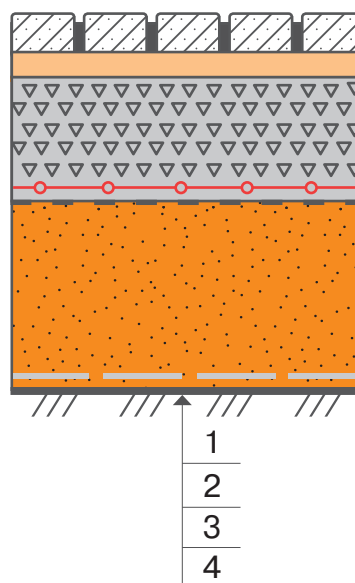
Конструктивная схема дорожной одежды с покрытием из плит бетонных тротуарных BRAER Группы VII
